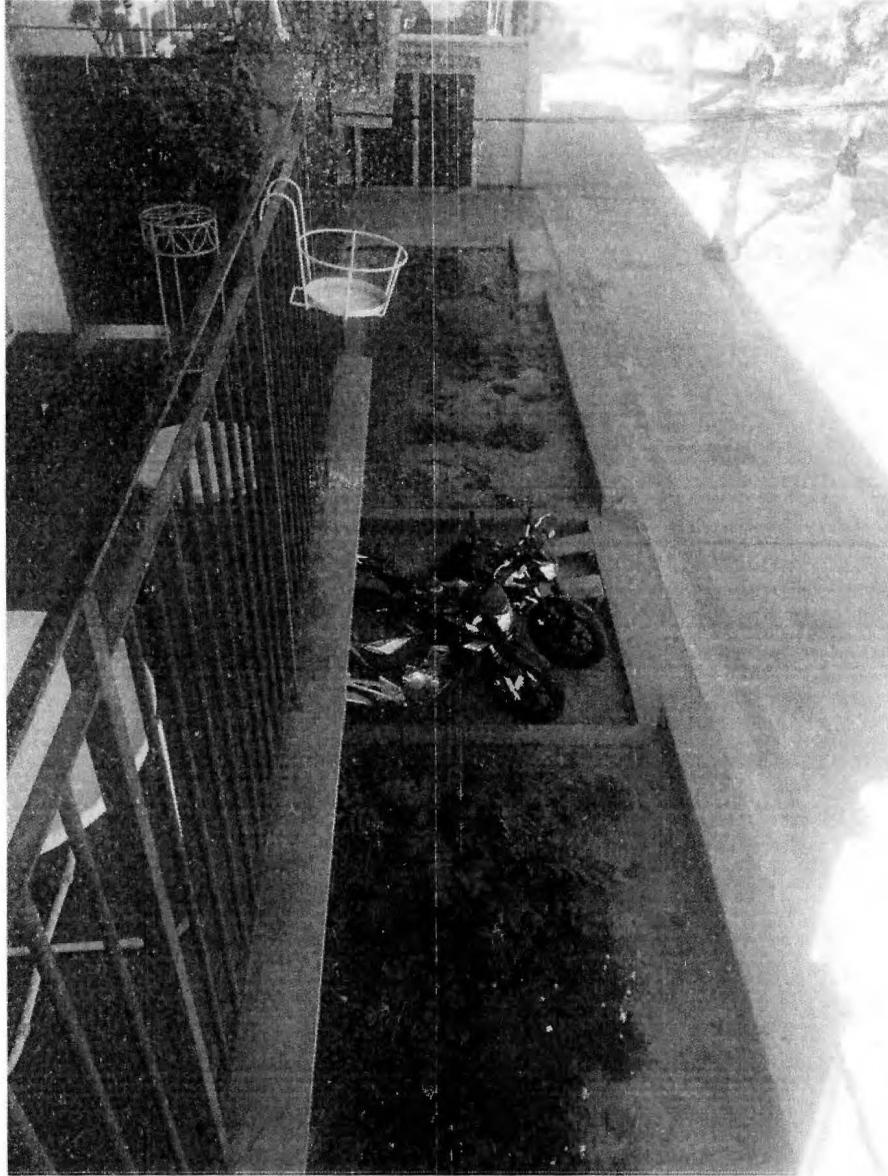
Vista general de balcones y áreas exteriores a reparar, muro exterior, nicho de gas, jardinera y bancas de hormigón
